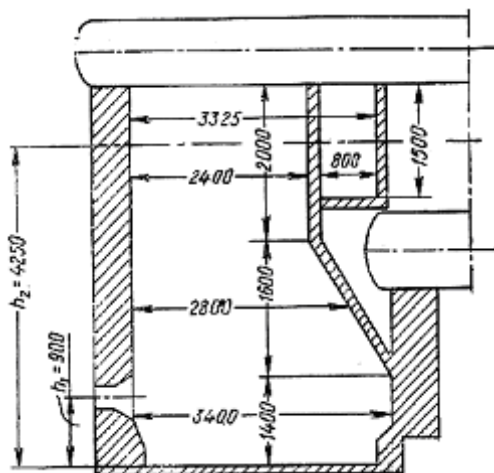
Схема топки котла ДКВР-10 и её основные размеры
